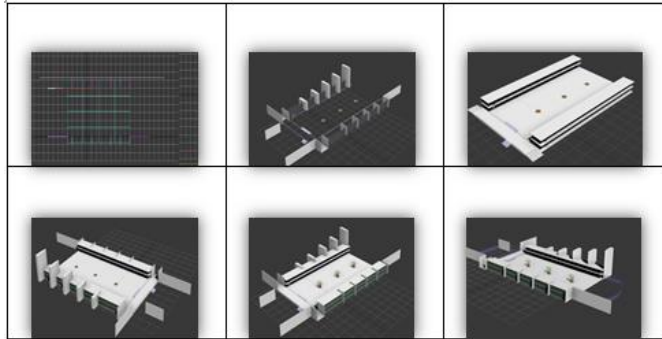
Construcción Zona Universitaria (Autoría)
